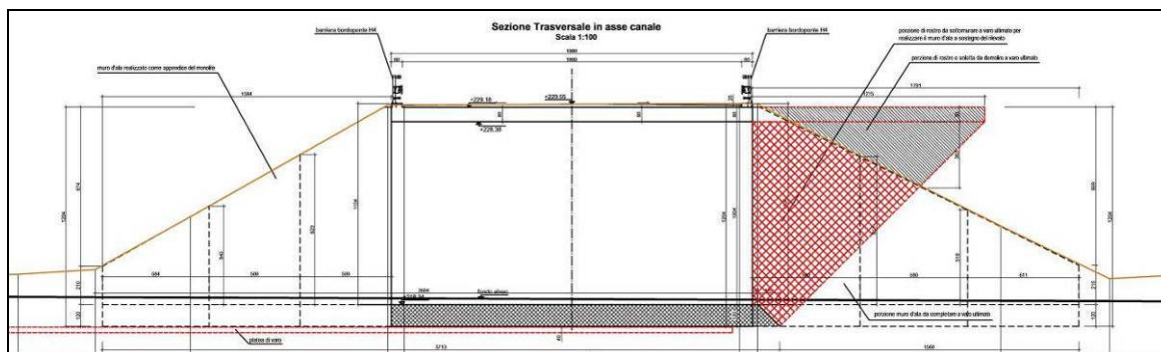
g – Sezione tipo con gaveta centrale
